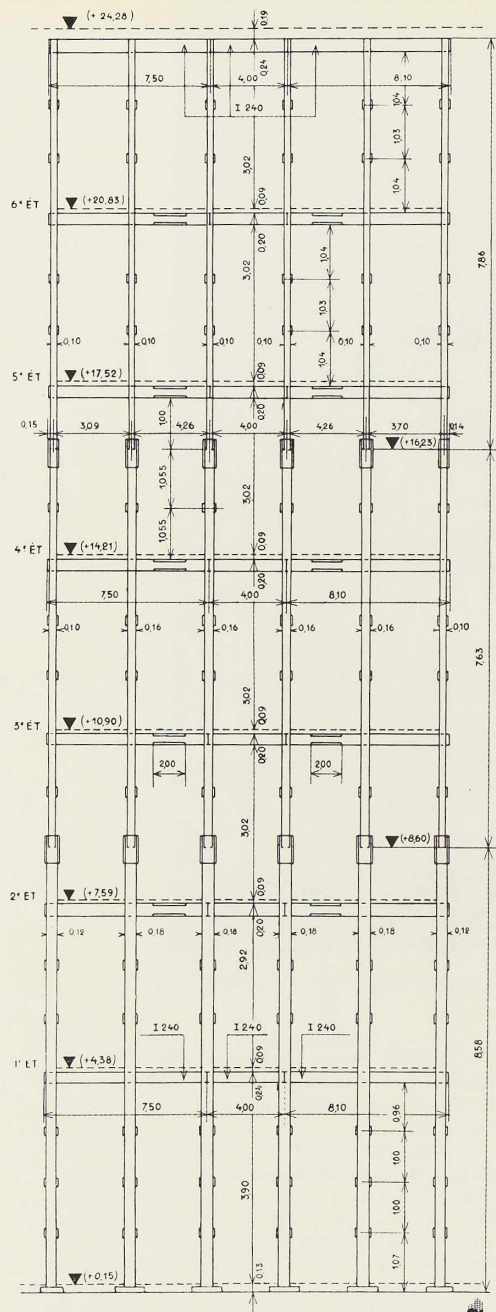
Plan d'un portique (ce plan est à échelle différente en hauteur et en largeur).
